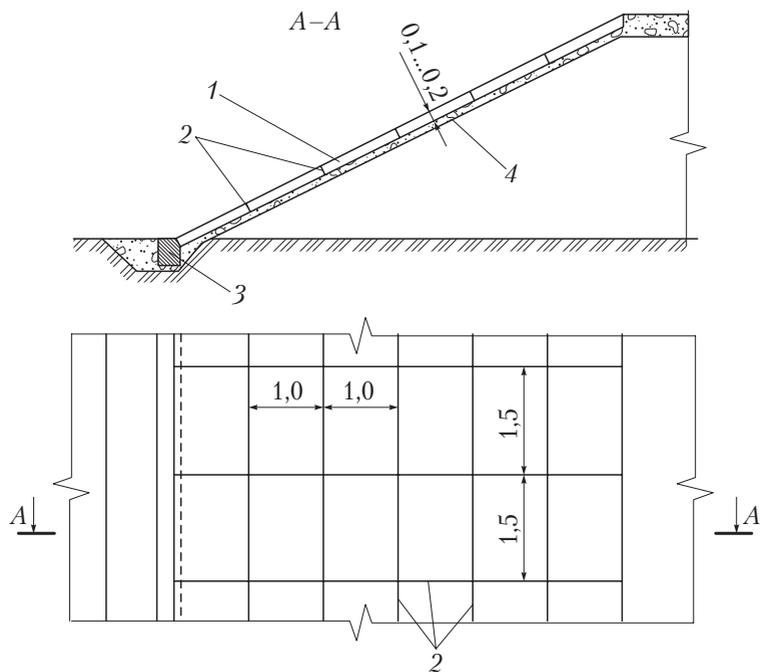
Укрепление откоса сплошным бетонированием:
